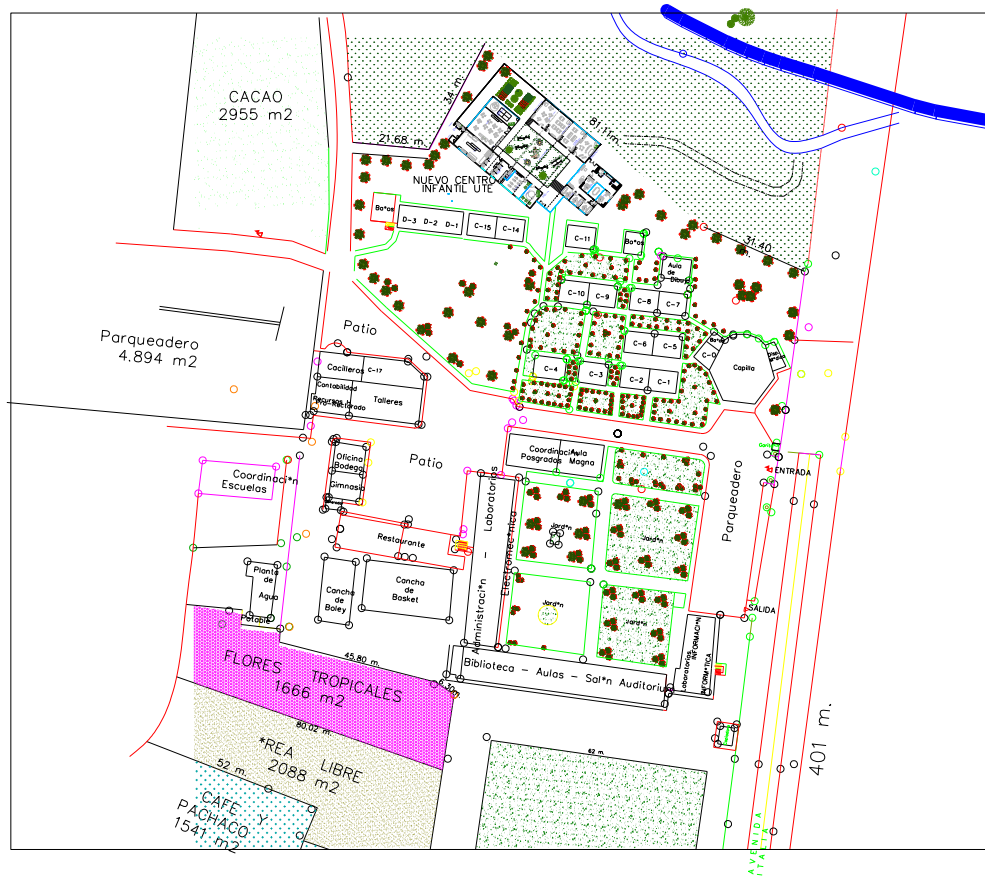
Implantación UTE Sto Dgo. Tsáchilas
